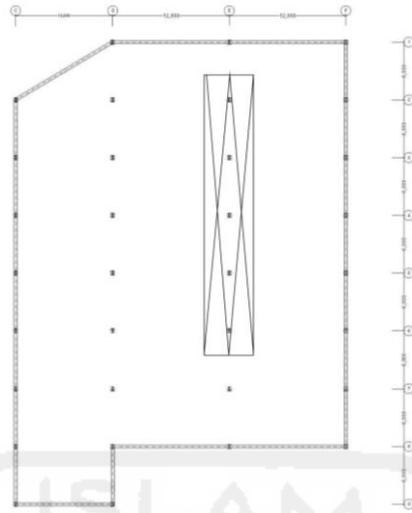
Skematik Struktur Lantai Dasar Area Bahan Pangan
